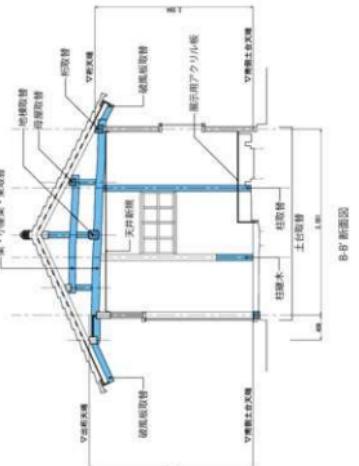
災屋 修理前 平面・立面・断面図 S=1/80
